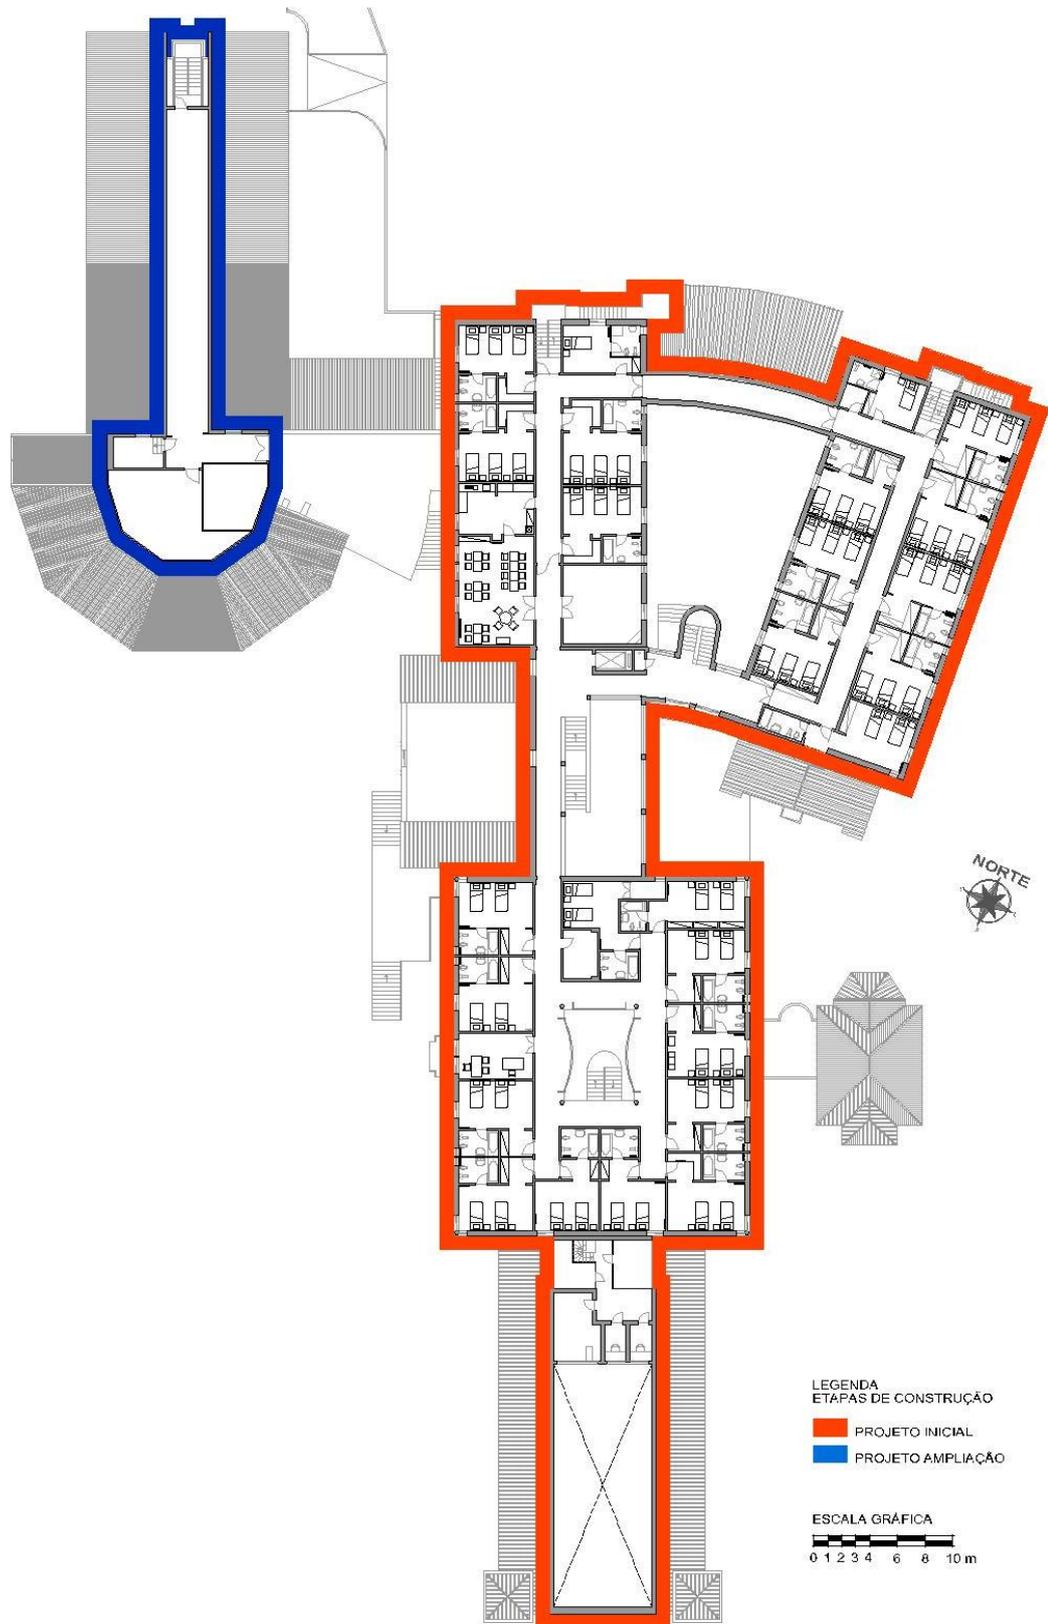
ILPI 1 - Planta Baixa Geral - 2º pavimento.
